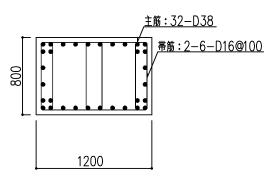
柱の配筋図(地下2階, X34/YC通り, 柱脚部)(単位:mm)
